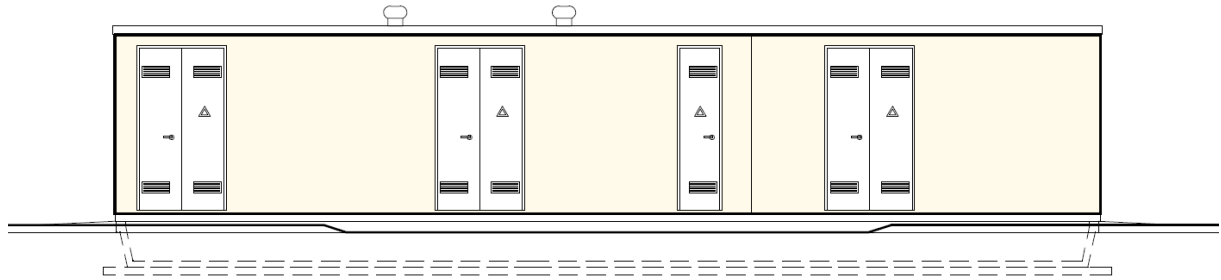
Prospetto frontale della cabina MT/BT (Via Arrio)
